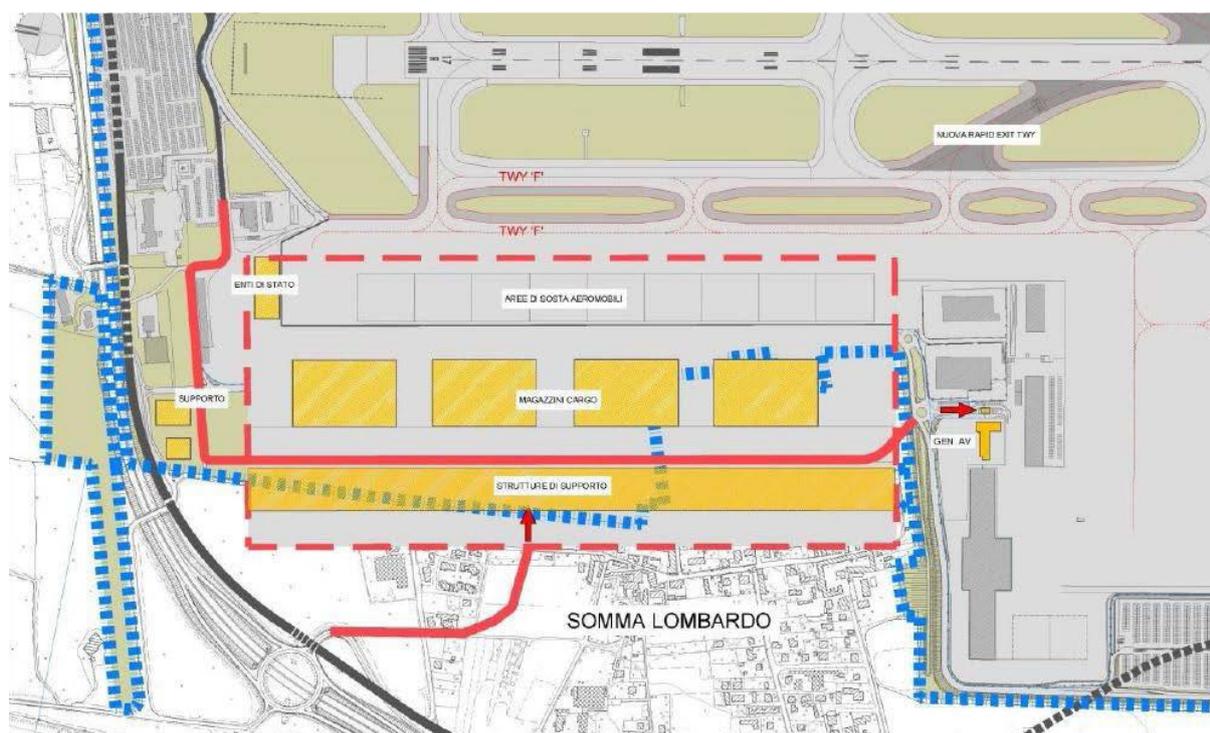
Ipotesi 1 (alternativa 4) schema di layout fonte: Masterplan 2035
